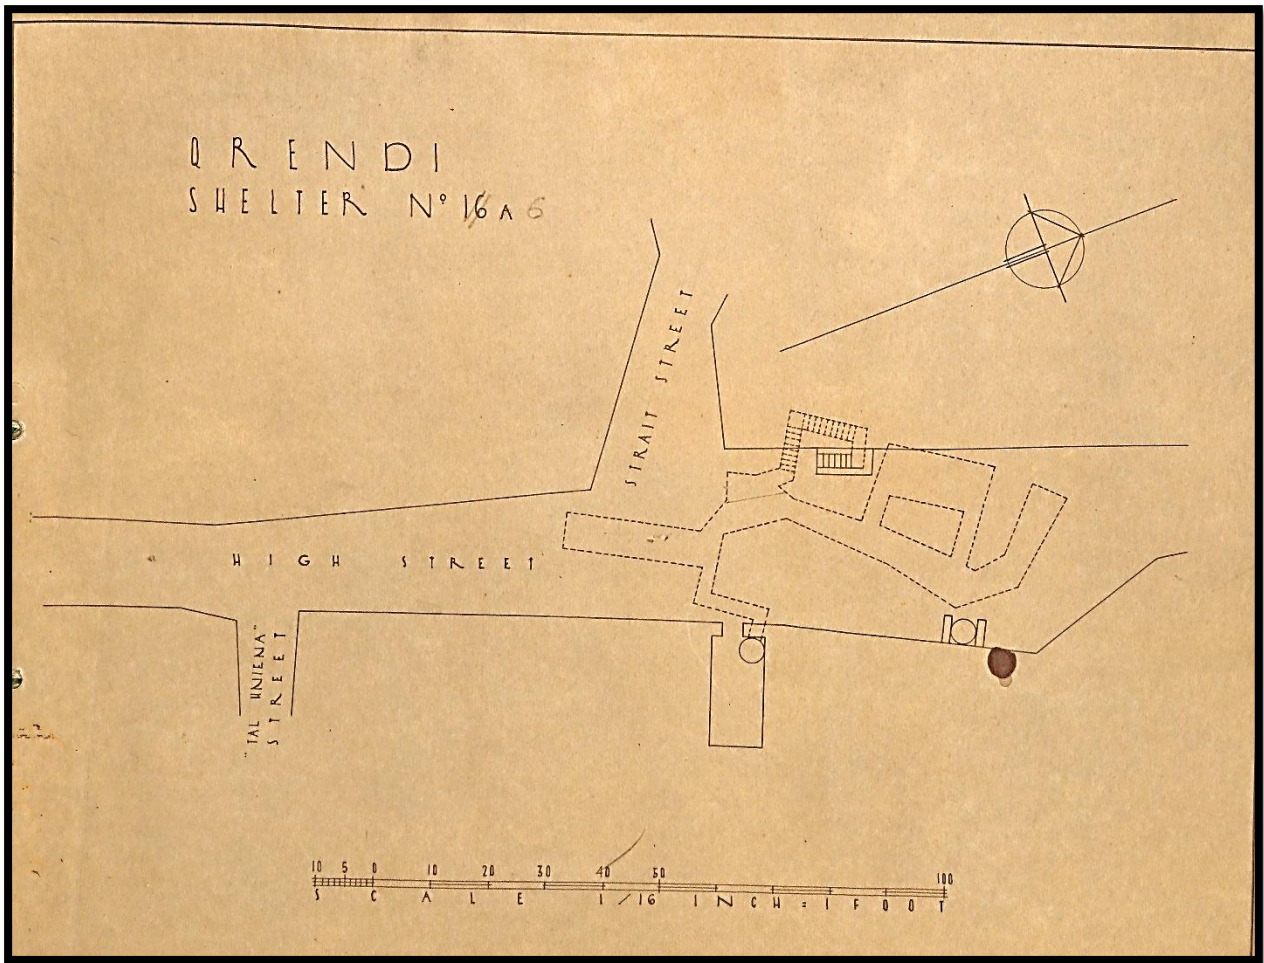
Planta do Abrigo nº6 "Tal – Hniena Street - High Street – Strait Street"
